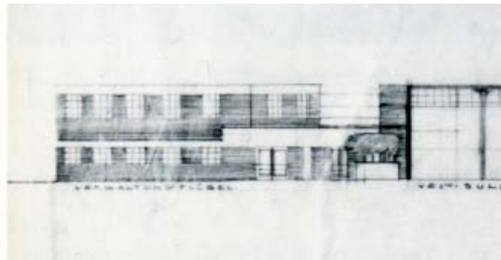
y 6 Fragmentos de la planta y de la sección del mercado de ganado de Lübeck (1924) donde puede verse la posición de la escultura del toro y la forma en planta del espacio que preside. Fuente: SCHIRREN, 2001. 155.
